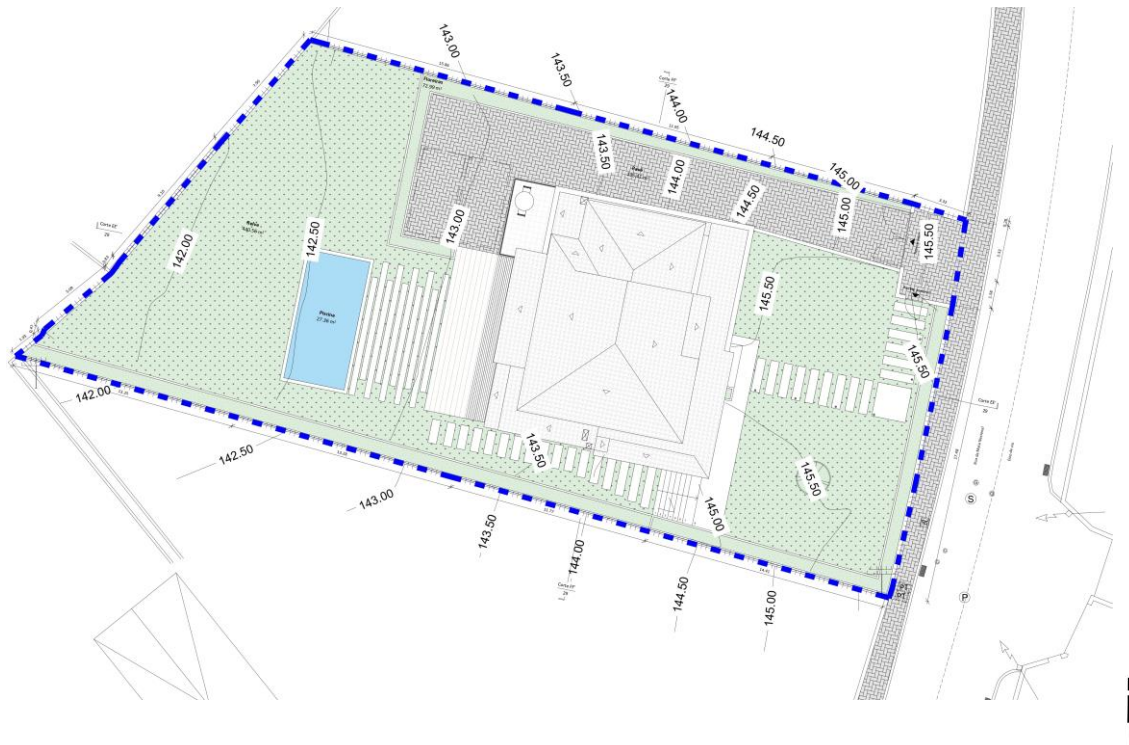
Proposto - Planta de implantação sob. lev. top. e arranjos exteriores (LIC_R00). Fonte: Garq / Desenvolvimento: Autora.
